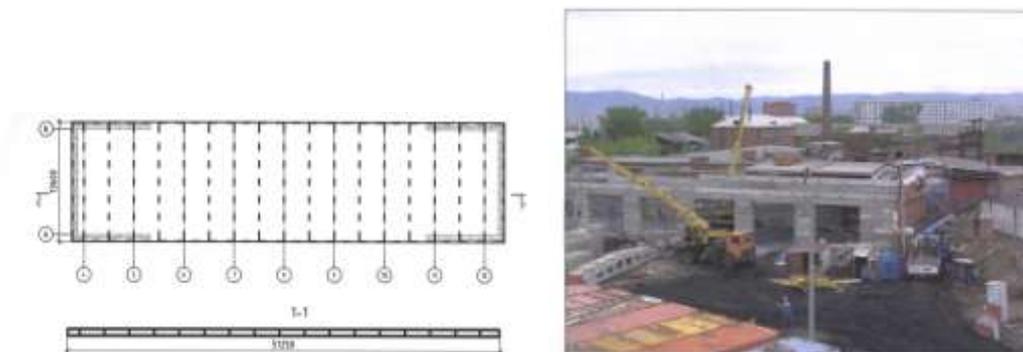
Монолитный фундамент (ПФП) и здание склада строительного оборудования
